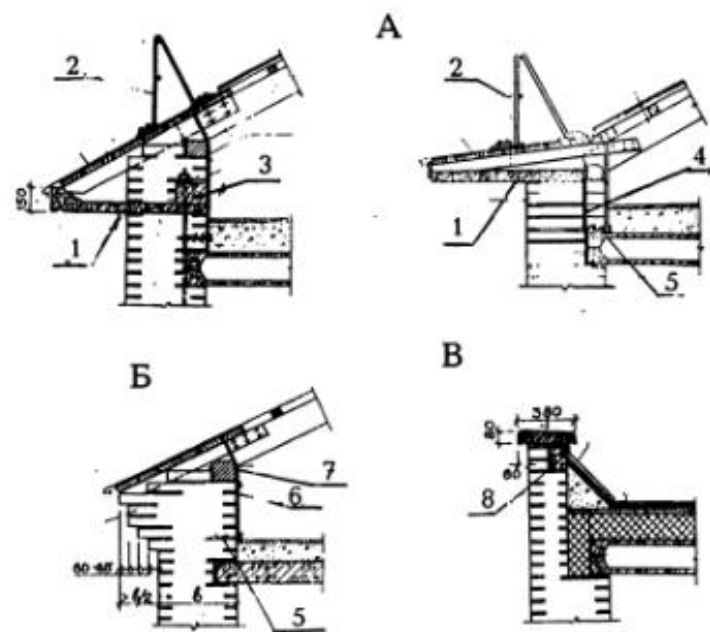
Конструкции карнизов в зданиях со стенами из кирпича: А - из железобетонных плит; Б - напуском кирпича; В - парапет в покрытии с внутренним водостоком; 1 - карнизная плита; 2 - ограждение кровли; 3 - анкерная балка; 4 - стальные закладные элементы; 5 - брш; 6 - скрутка; 7 - мауэрлат; 8 - закладной камень
